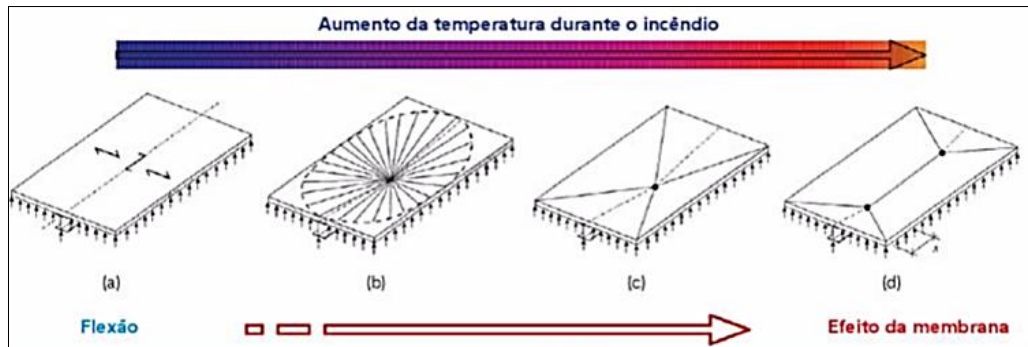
Comportamento de uma laje e viga mista em situação de incêndio
